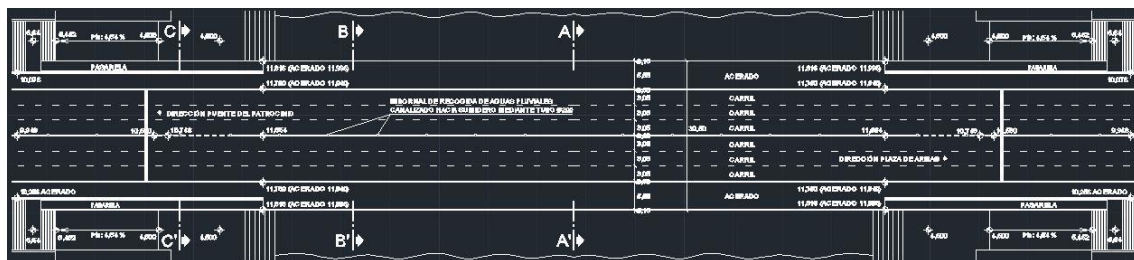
Vista de la representación virtual en planta del puente con cotas e información constructiva.
